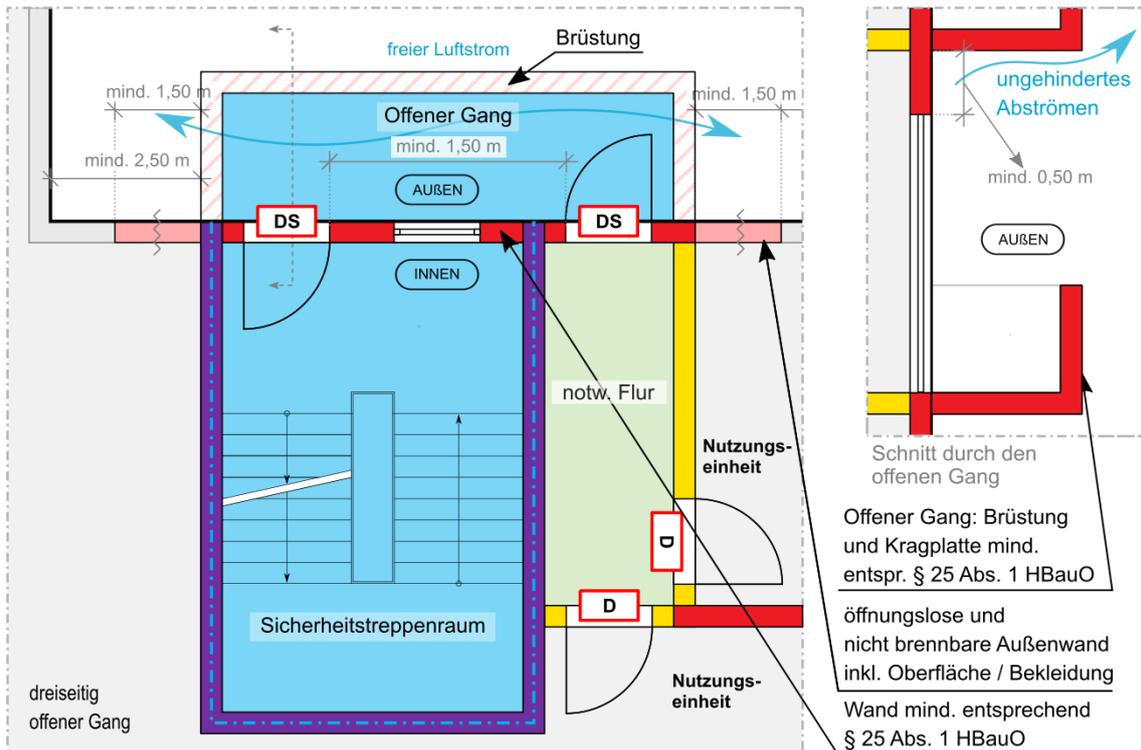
Prinzipskizzen (Grundriss/Schnitt) - außenliegender Sicherheitstuppenraum mit dreiseitig offenem Gang
